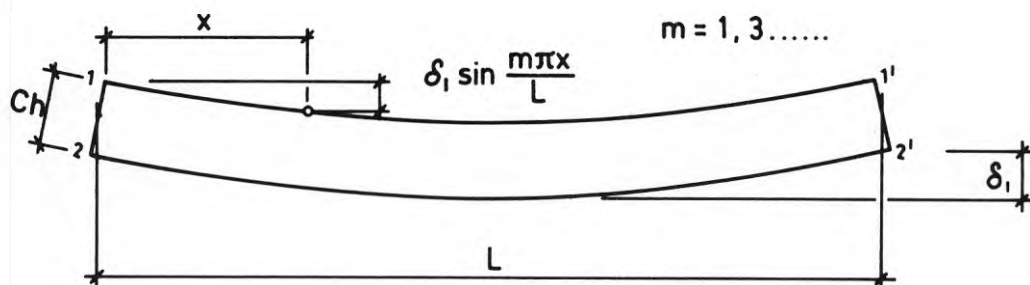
4 Profileringsens deformation i plåtens eget plan. (Falkenberg, 1968 b.)
